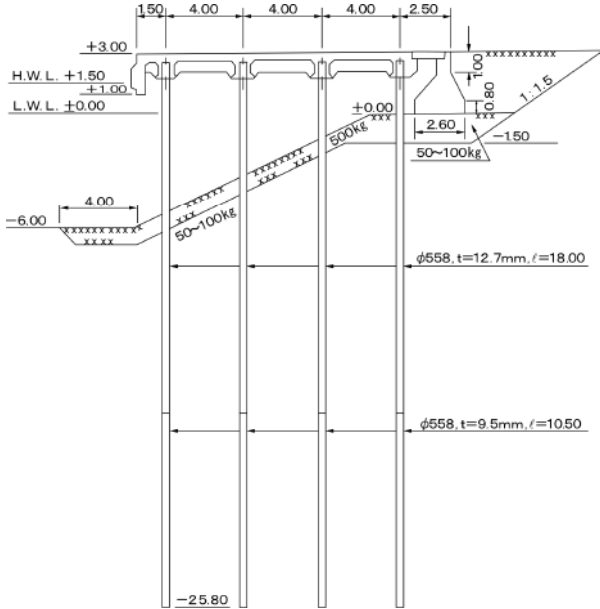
諏訪下地区栈橋 (-6.0m) 標準断面図
